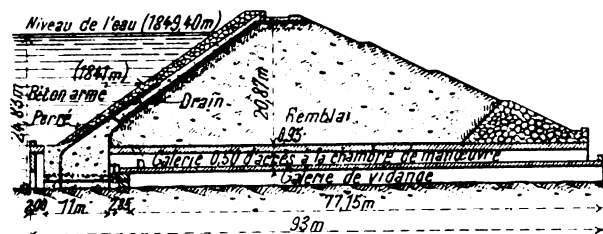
Profil du barrage d'Orédon construit en enrochements. Coupe en travers avec détails du revêtement, le perré enlevé.
